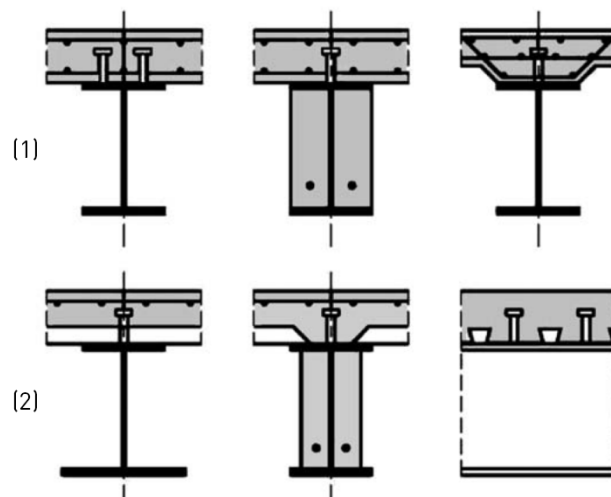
Типовые поперечные сечения сталежелезобетонных балок с монолитными плитами (1) и плитами по профнастилу (2)
